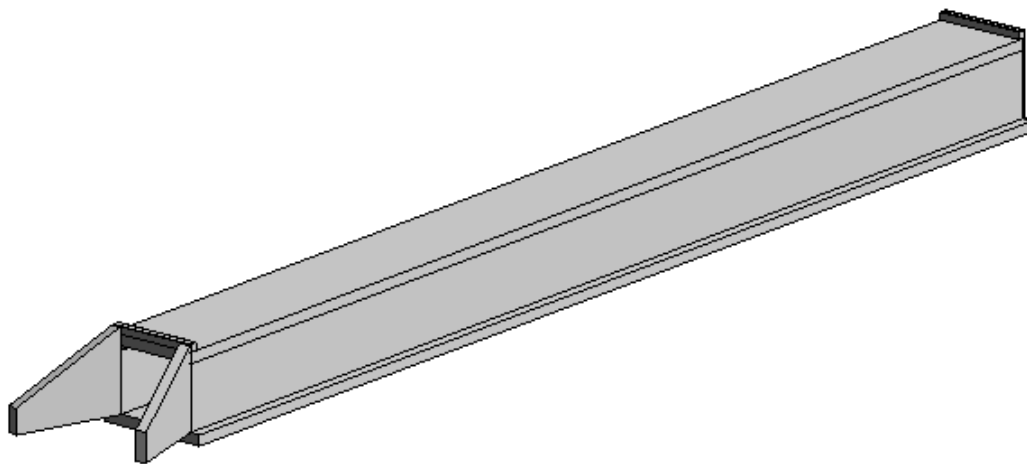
Gyllbekken bekkekulvert, sett mot øst (Kilde: Norconsult)
